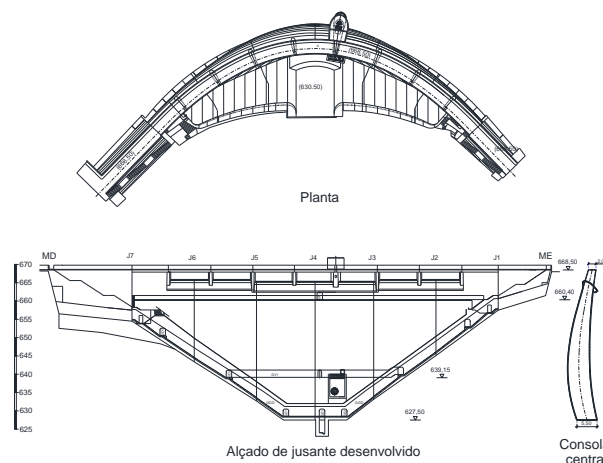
Barragem do Alto Ceira II. Planta, alçado de jusante desenvolvido e corte vertical pela consola central
